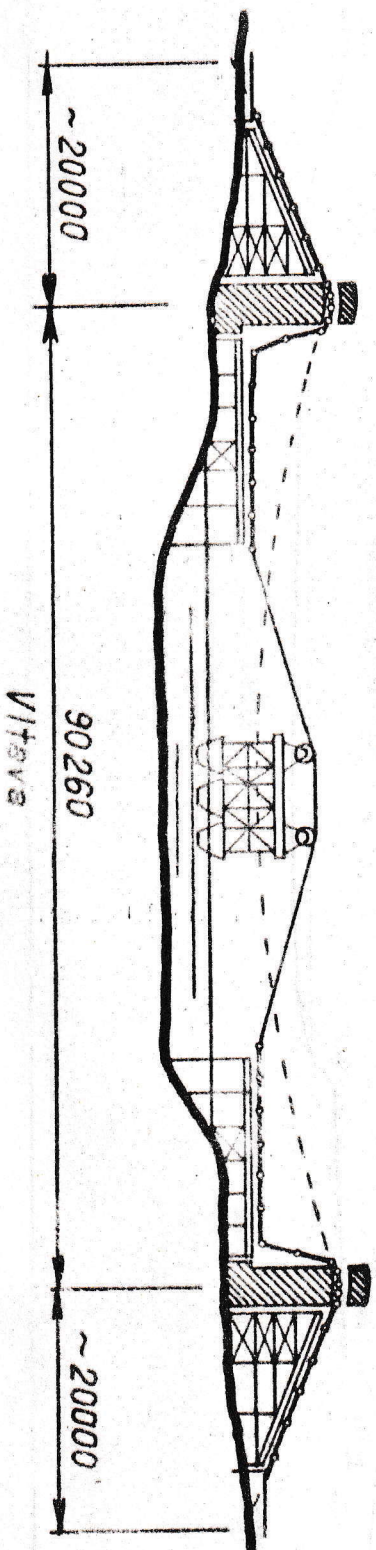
FIG. 41.4. Obraz mostni techniky minulého a současného století
